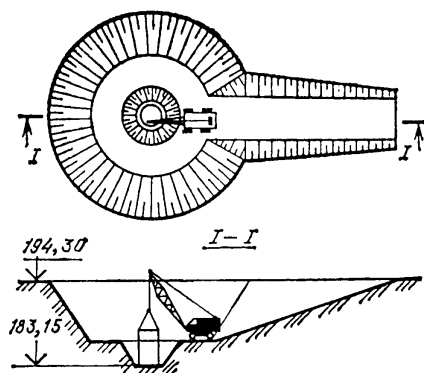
Схема котлована для заглубленной насосной станции
